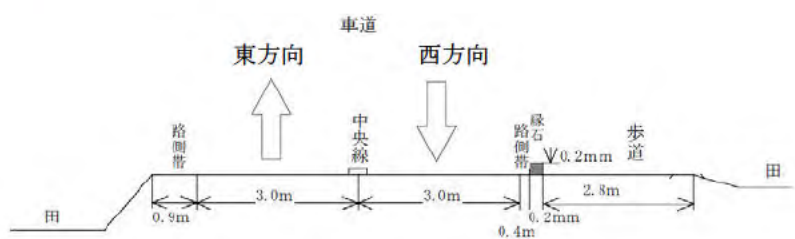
騒音予測地点d近傍の詳細図及び道路断面図
